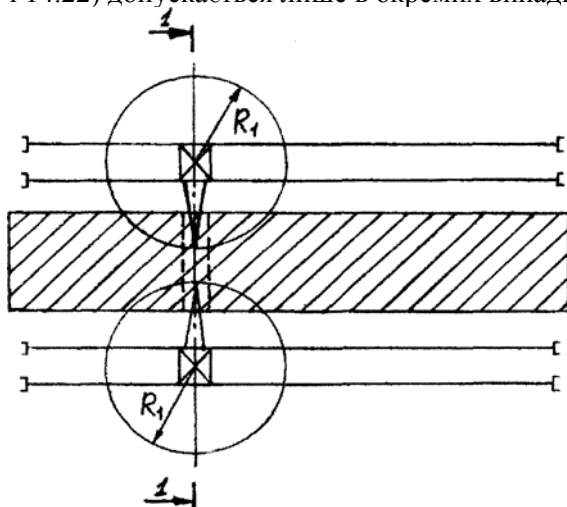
Схема розміщення в плані баштових кранів при монтажі ними елемента покриття
